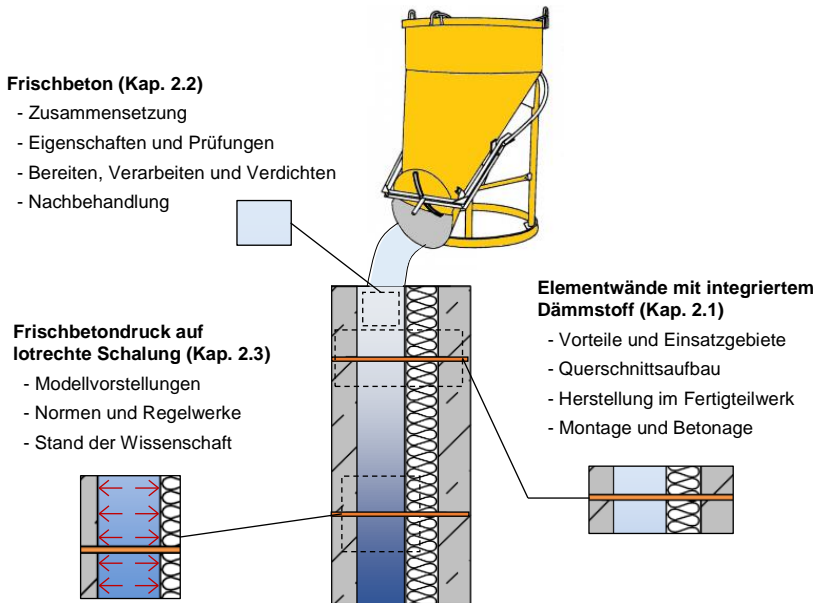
Überblick über Elementwände und Frischbetondruck
